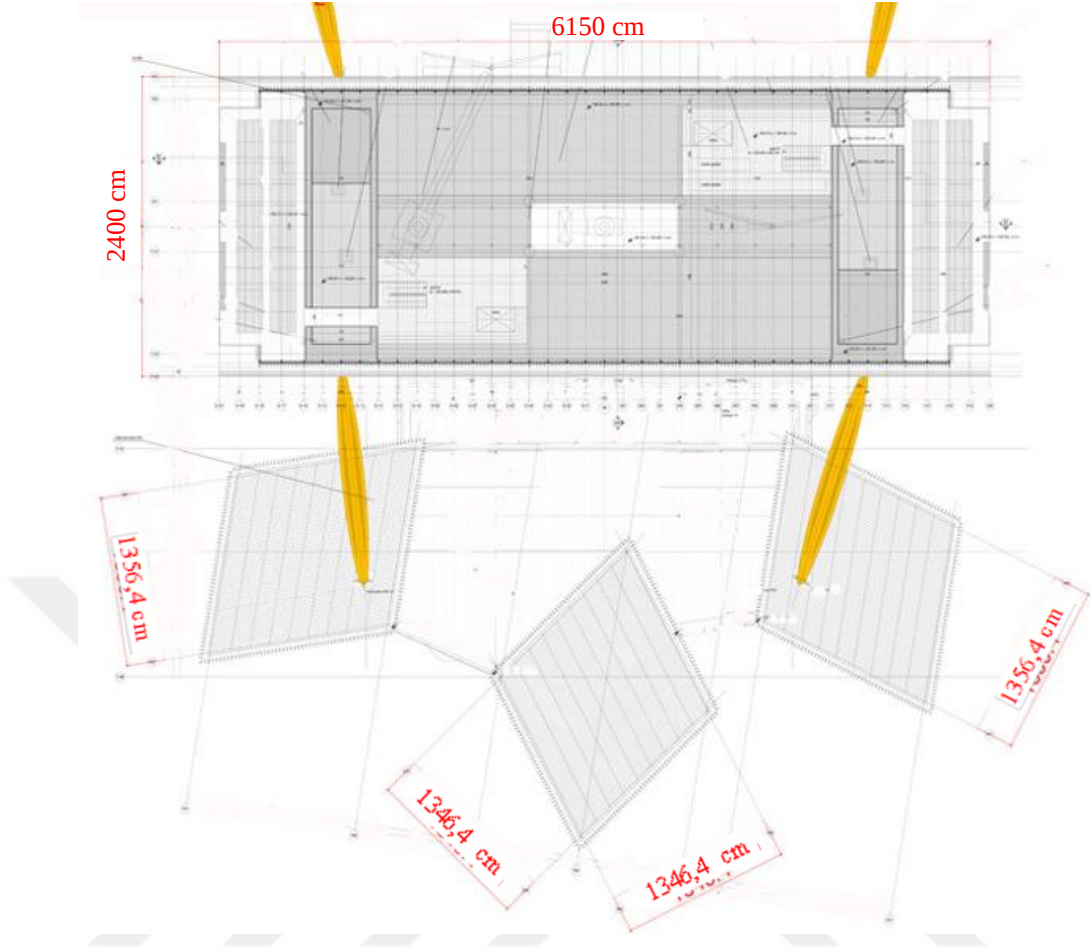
Allianz Tower zemin kat planı (Archdaily, 2015)
